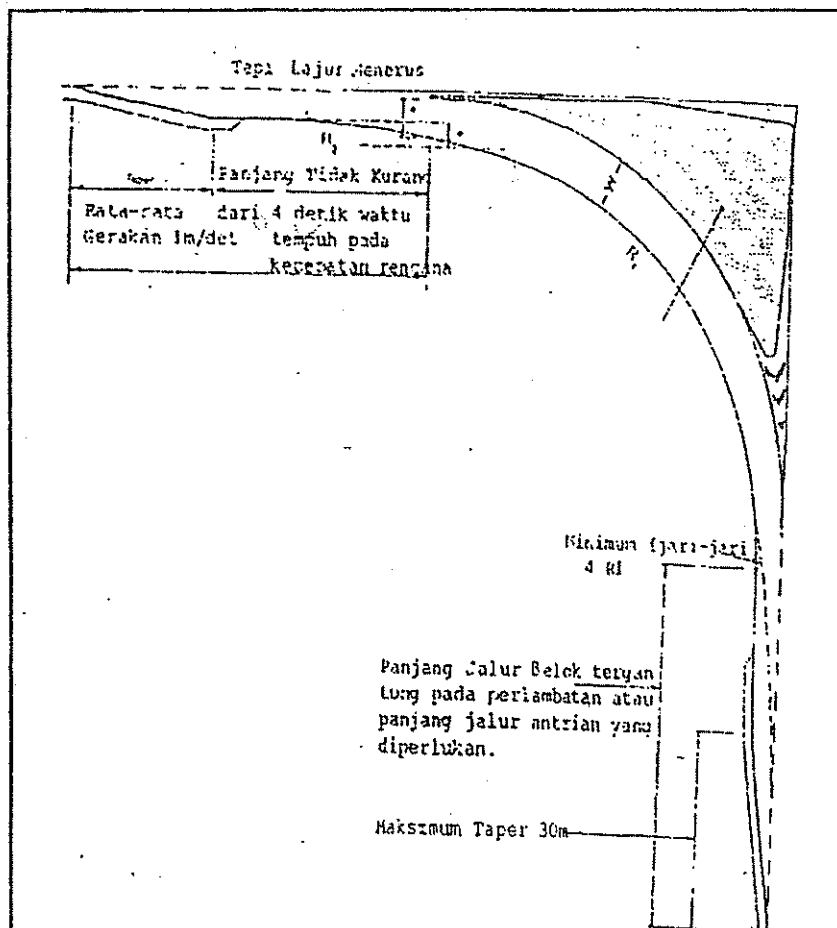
Lajur Belok Kiri dengan Pulau Lalu Lintas
